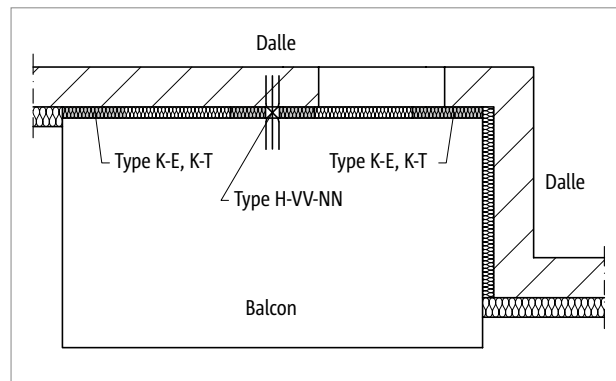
Schöck Isokorb® T Type H : Balcon en porte-à-faux
